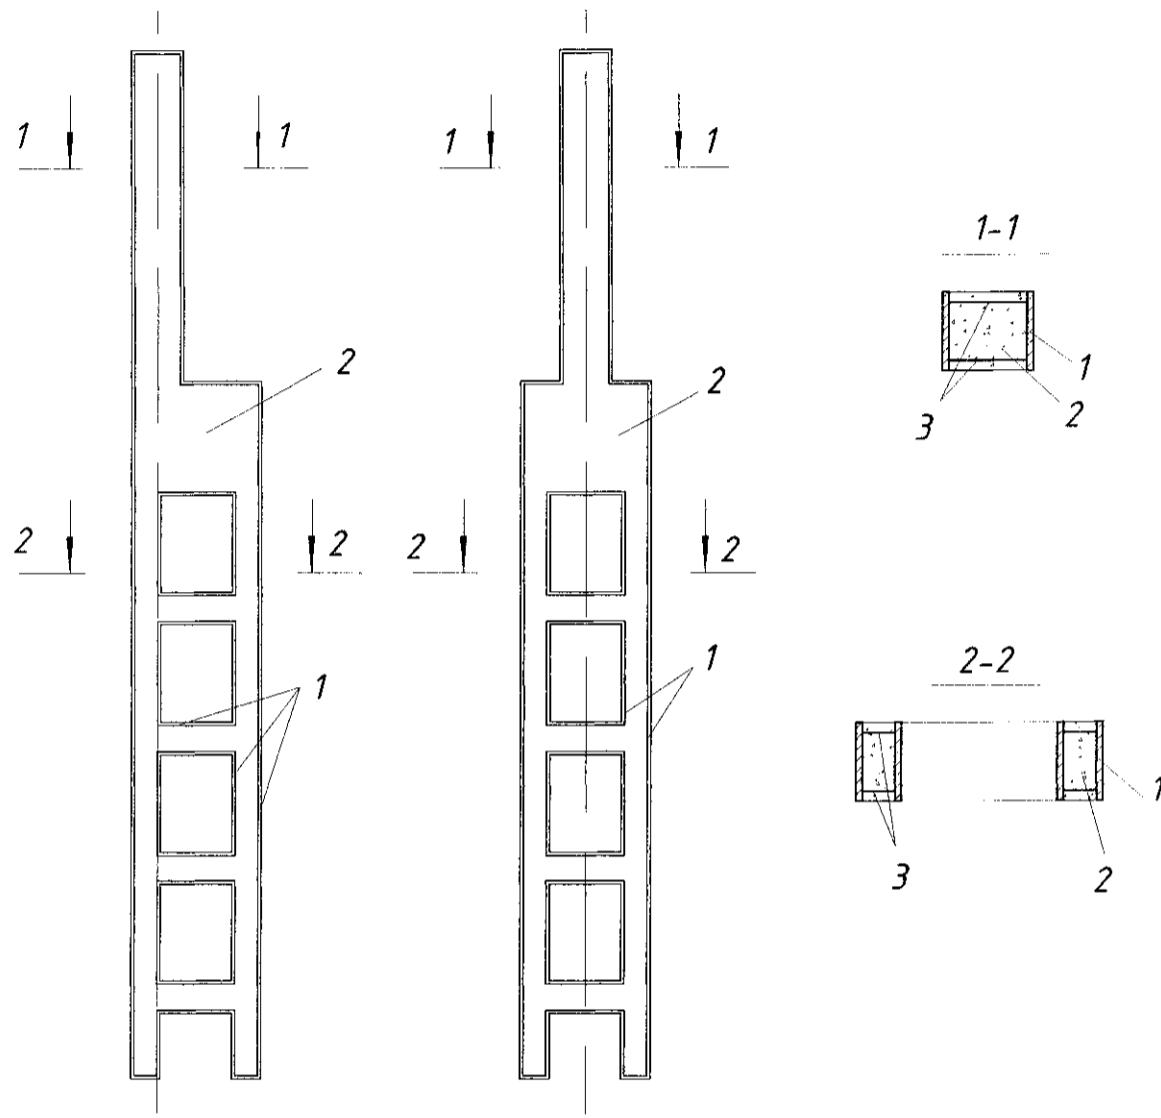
Наскрізна залізобетонна колона із зовнішнім листовим армуванням
